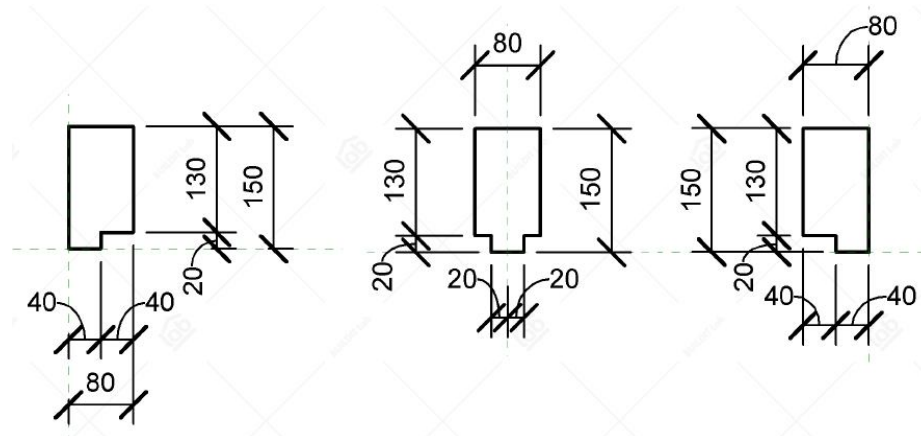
Профілі для оновлення Curtain wall mullion
